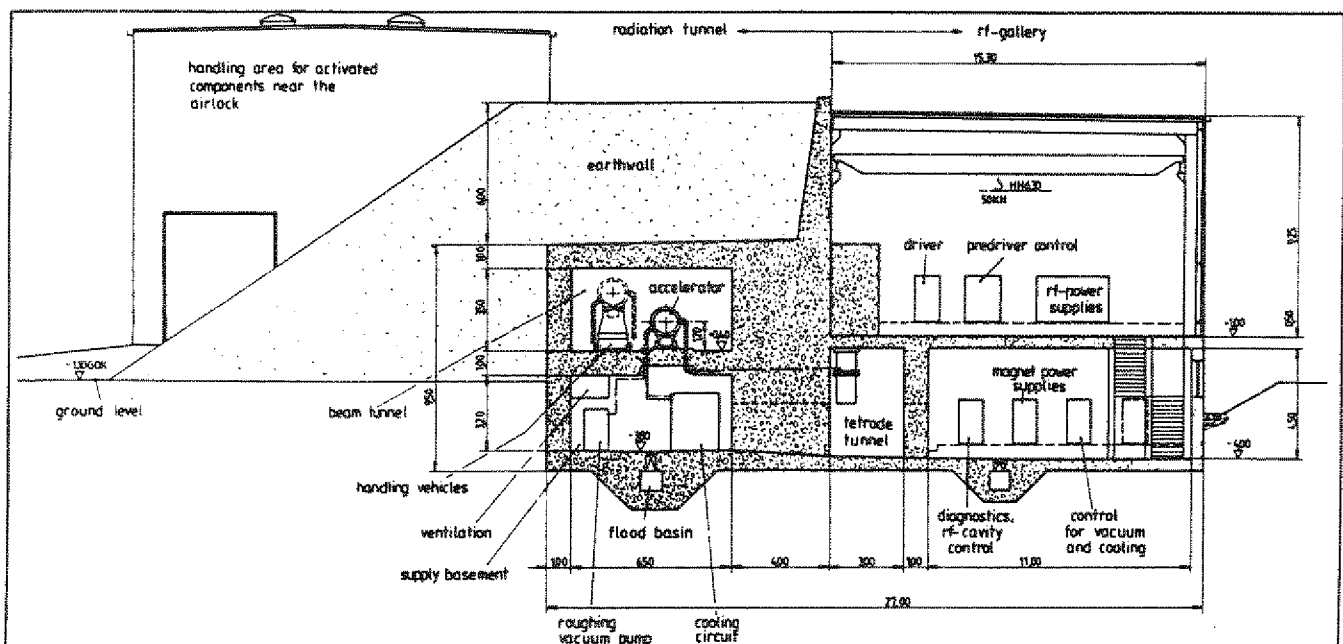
Technischer Layout des Beschleunigertunnels
